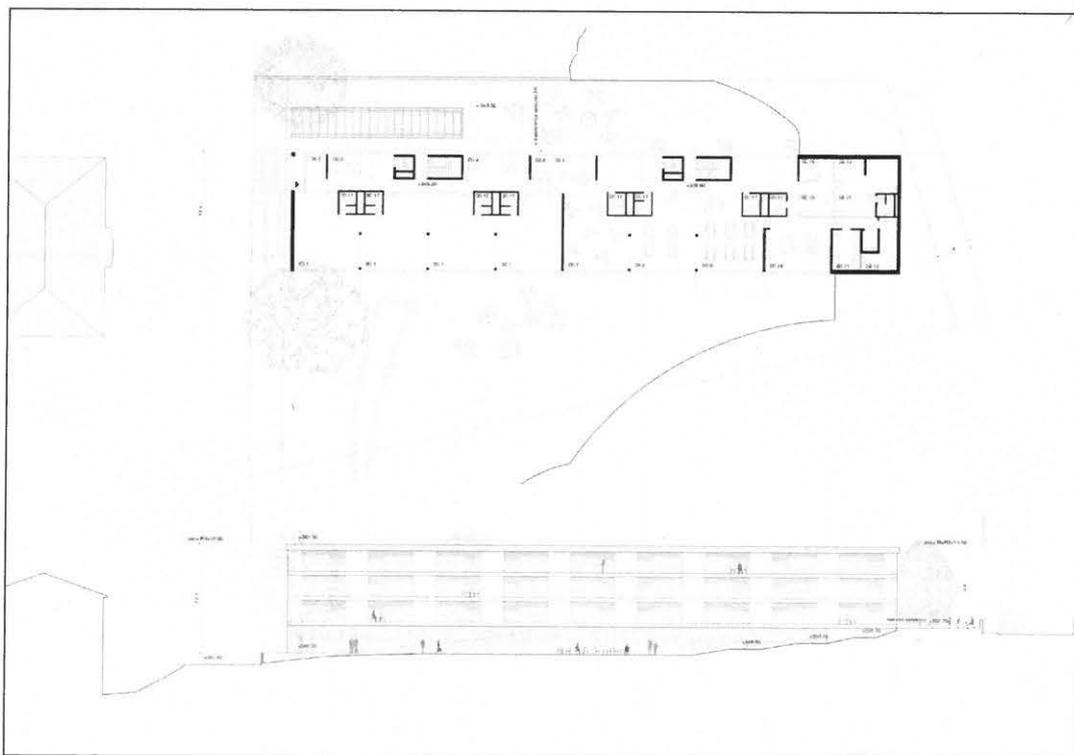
"Il limite del parco" - estratto piani provvisori di progetto, piano terra e facciata sud
